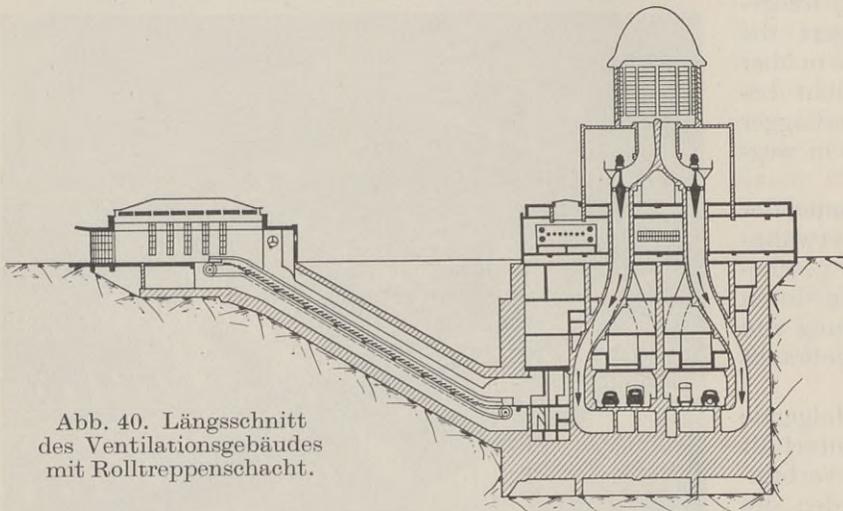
Längsschnitt des Ventilationsgebäudes mit Rolltreppenschacht.
